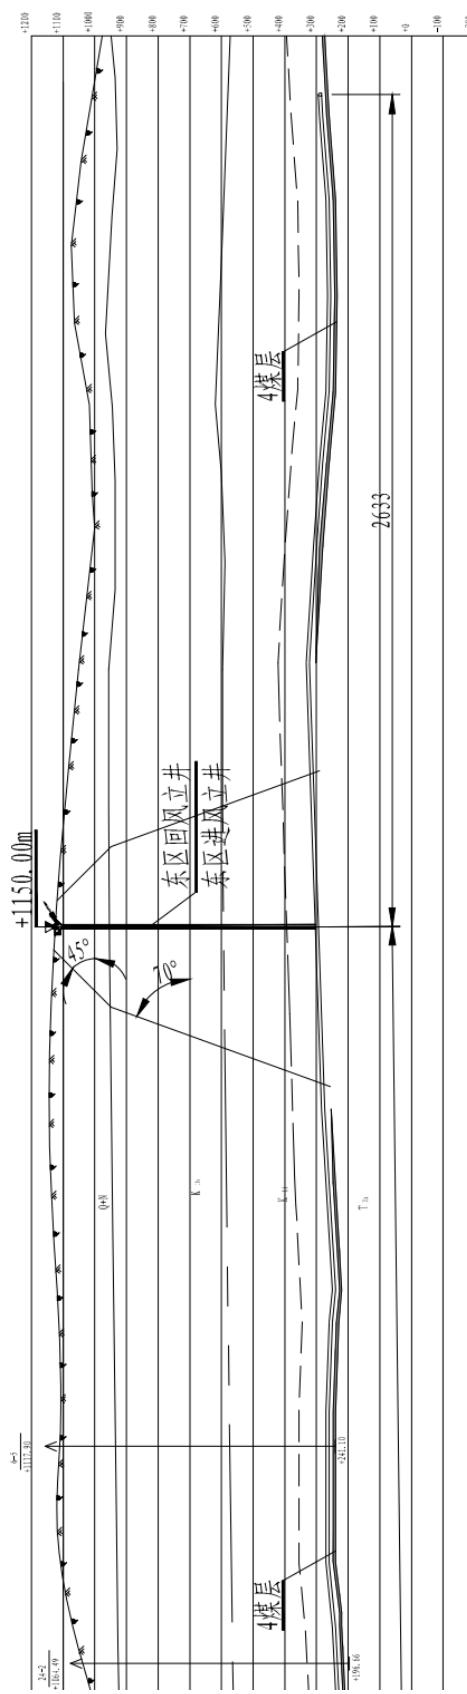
续矿井开拓方式 I-I 剖面图 (4-4)
